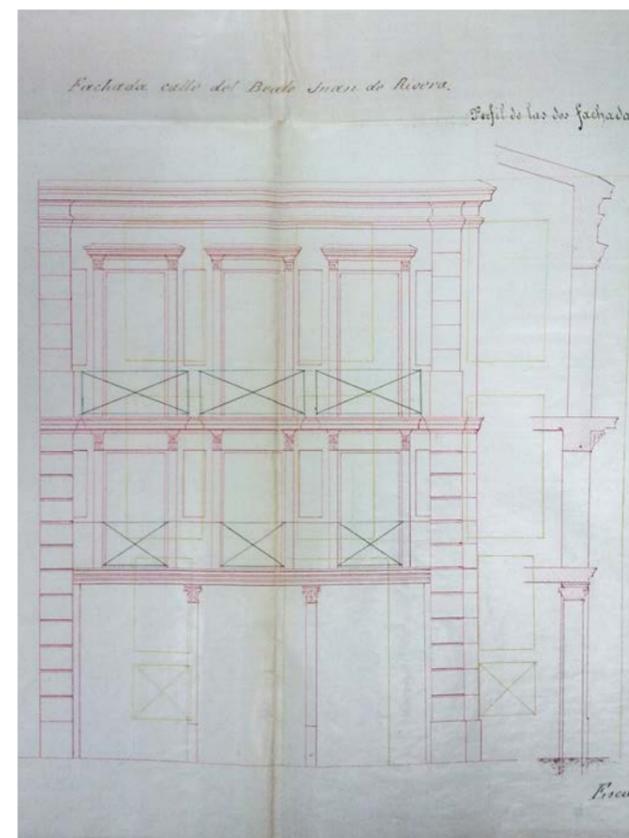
Fachada calle Beato (San) Juan de Ribera.
